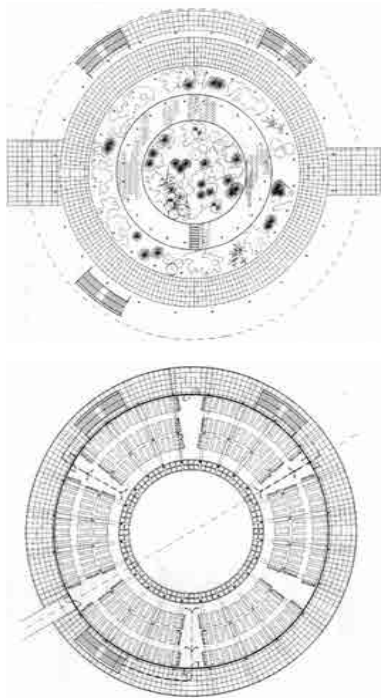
y Fig. 89 Comedores circulares. Planta baja (arriba) y planta alta (abajo).
